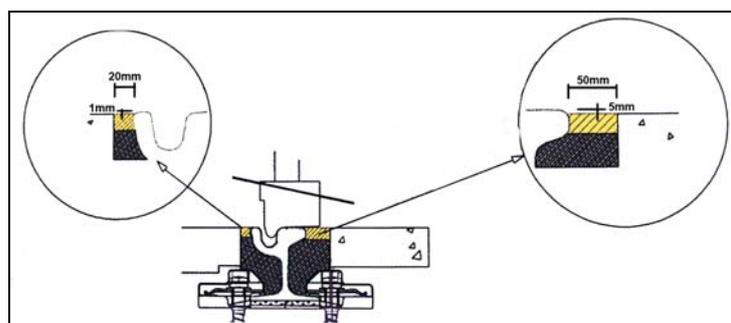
Particolare costruttivo del giunto rotaia-pavimentazione [1]
